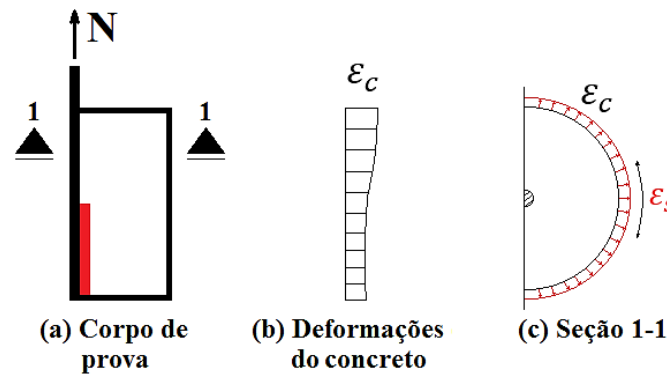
(a) Corpo de prova durante o ensaio, (b) Deformações que experimenta o concreto devido ao deslizamento da barra, (c) Deformações que experimenta a chapa de confinamento durante o ensaio.
